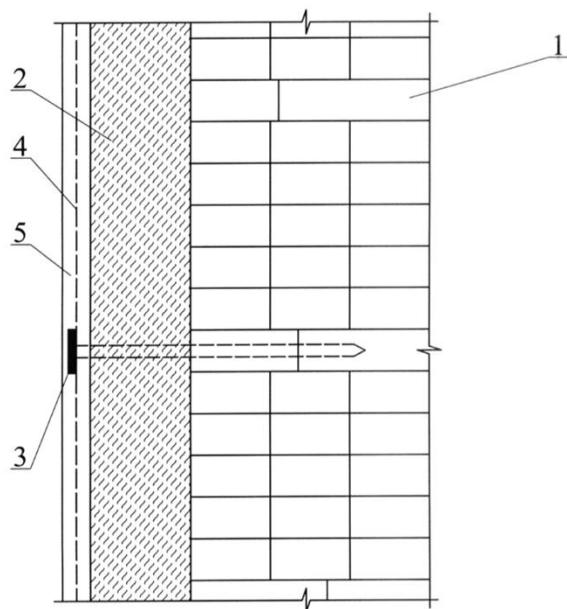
Вариант отделки фасада мокрой штукатуркой по пластмассовой сетке при утеплении стены снаружи:
